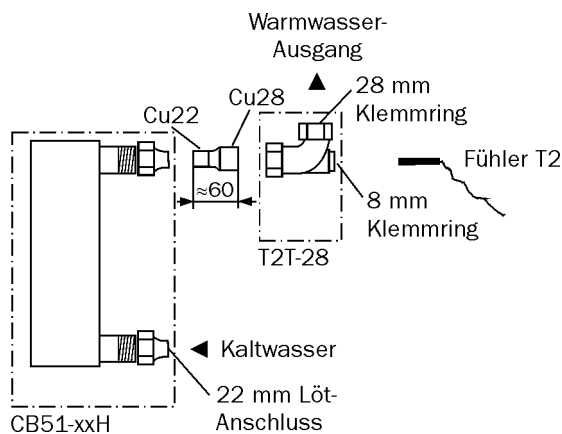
Position des Fühlers T2 mit T-Stück T2T-28
